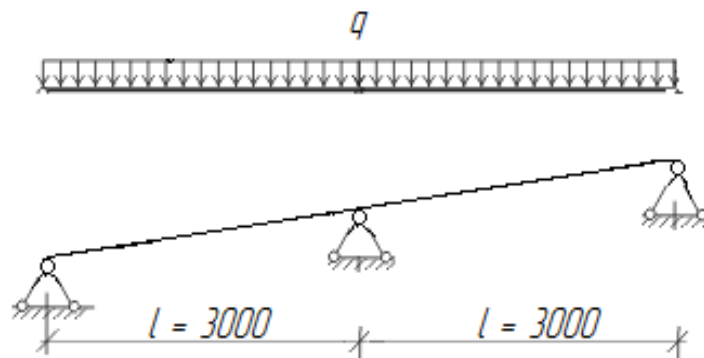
Расчётная схема двухпролётной неразрезной балки
